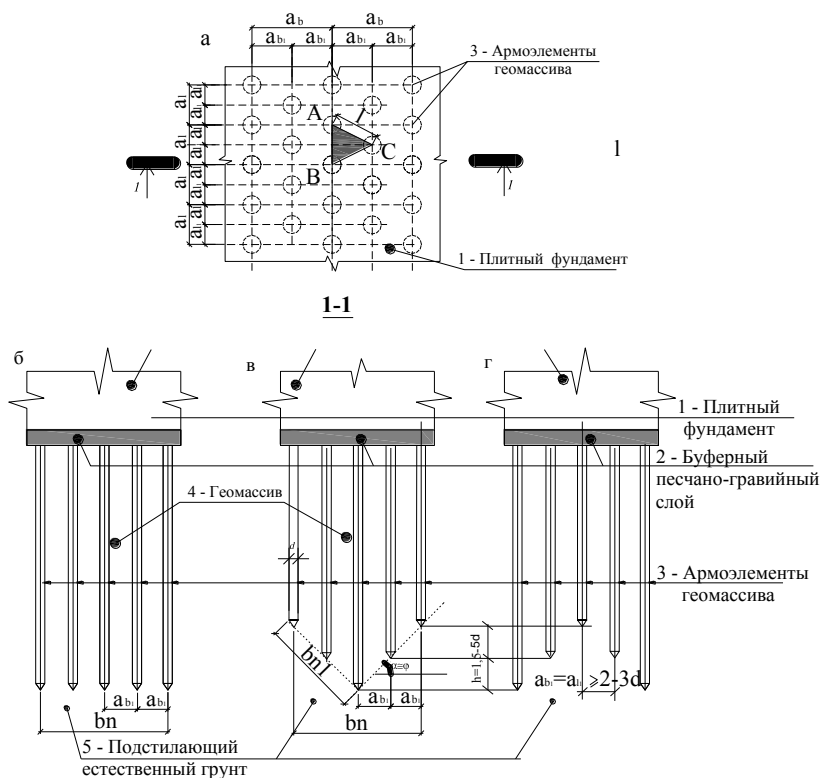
Схема вертикального армирования основания (геомассива) плитных фундаментов:
